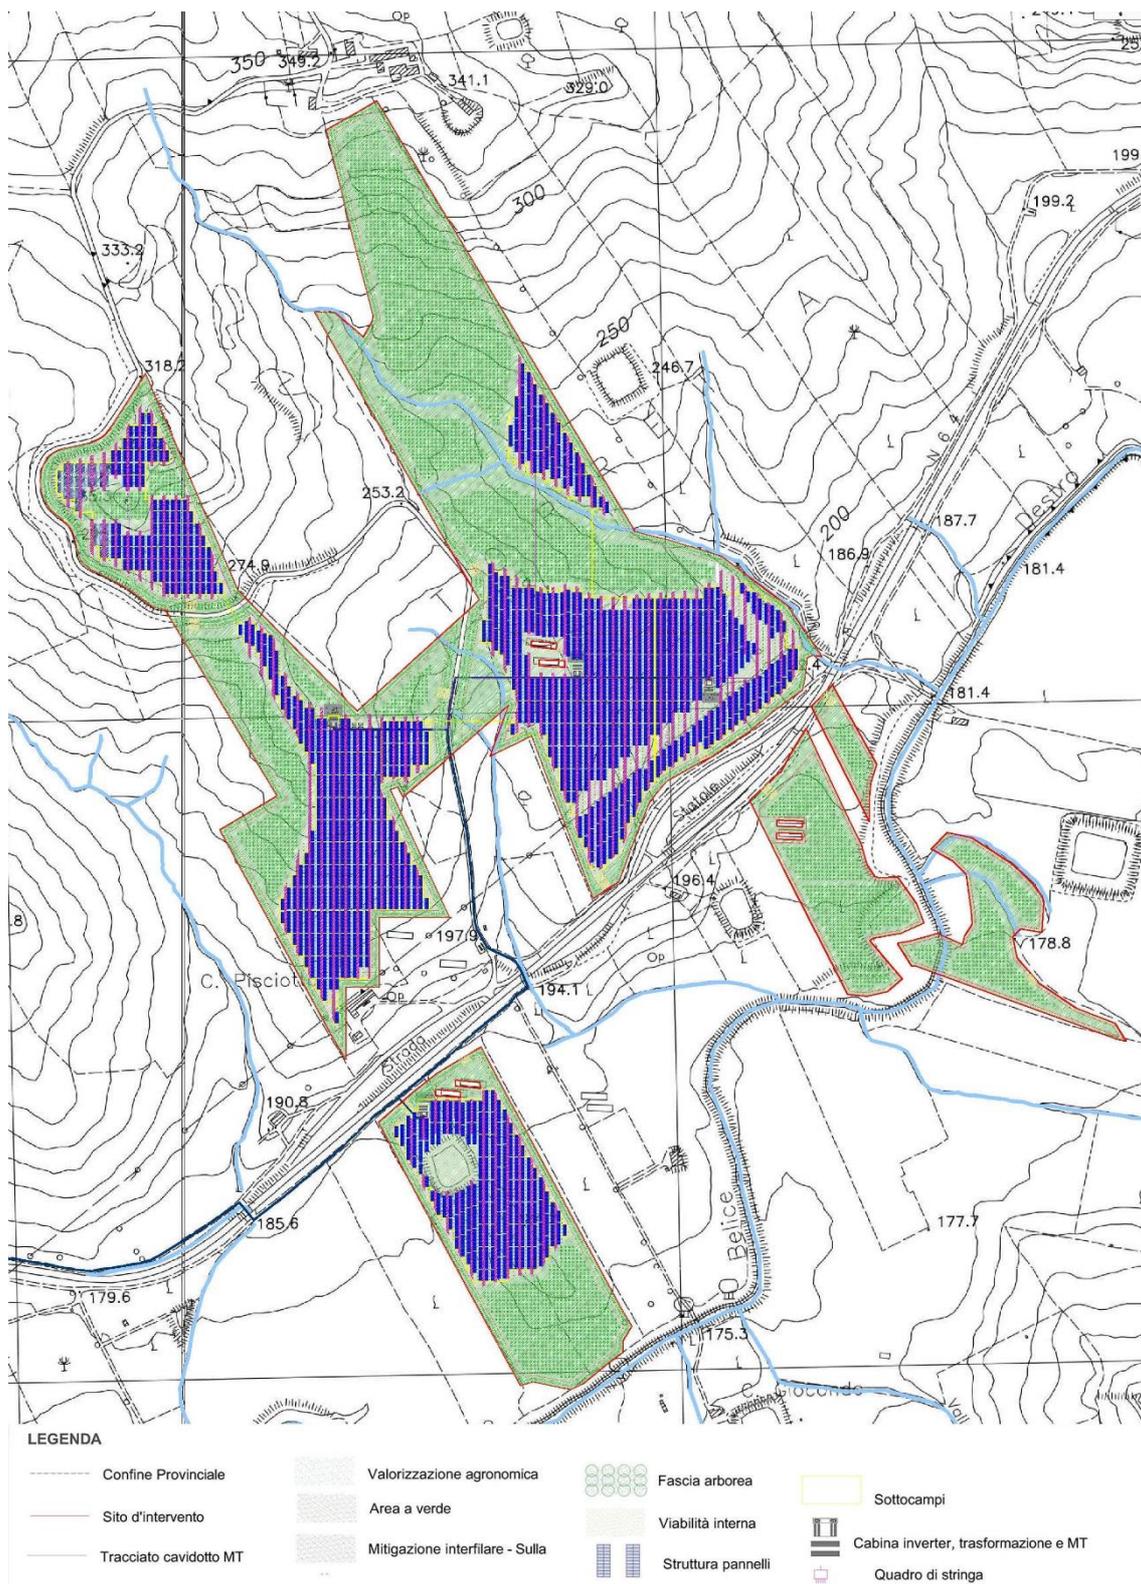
B – Layout dell'impianto ricadente in Contrada Torretta con cavidotto
